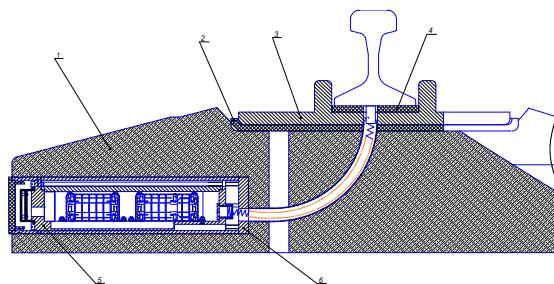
Фрагмент сборочного чертежа на монтаж устройства контроля и сбора информации: 1 - шпала, 2 - резиновая прокладка, 3 - подкладка, 4 - резиновая прокладка под подошву рельса, 5 - устройство контроля сбора и передачи информации, 6 - кожух
